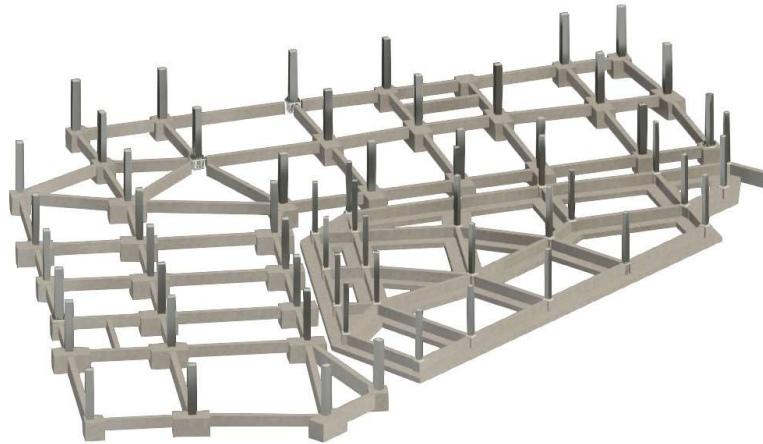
Modelado de la cimentación del edificio “The Yard” en Revit
